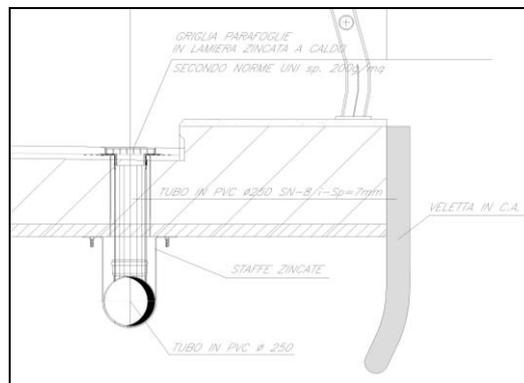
Sezione ferroviaria in viadotto-particolare drenaggio bocchettone grigliato
